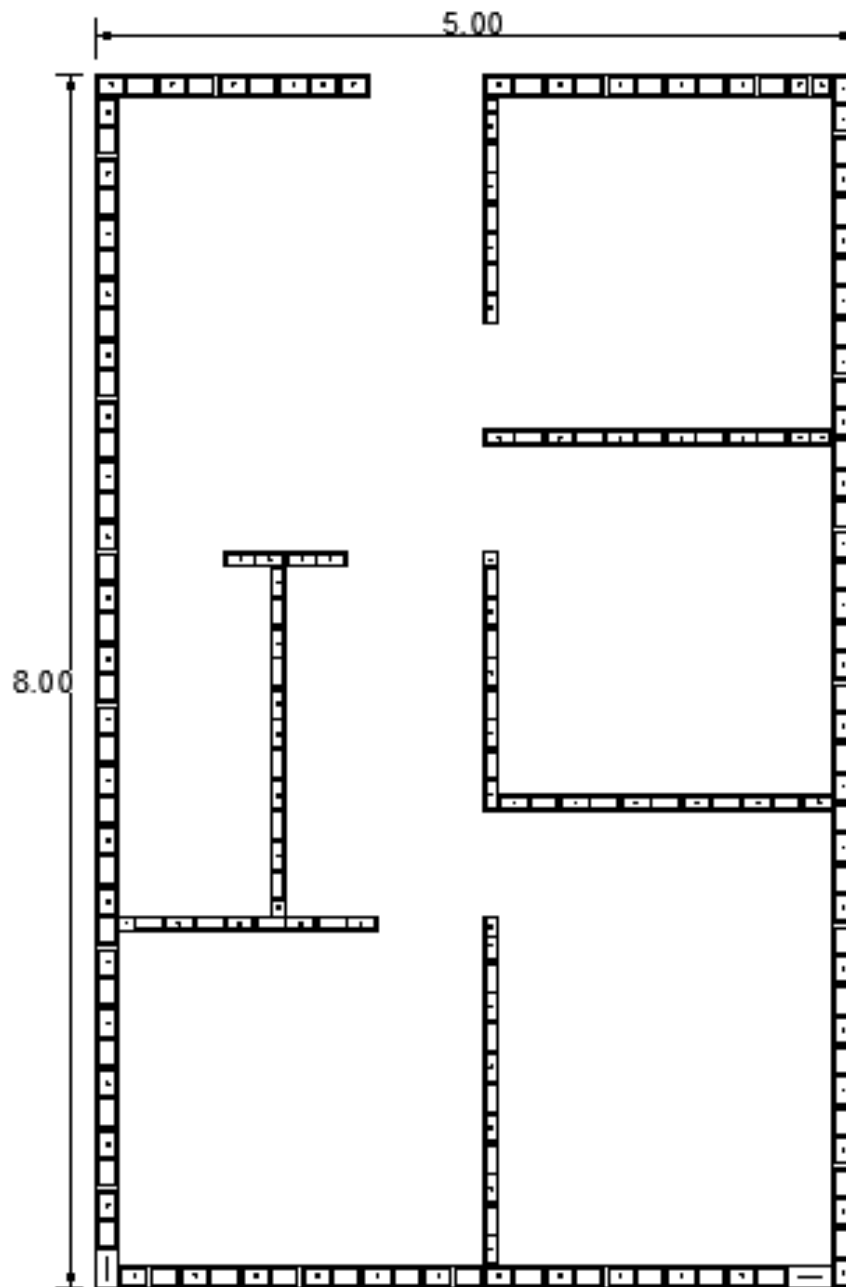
Planta de refuerzo de paredes de acuerdo a la Norma Especial para diseño y construcción de viviendas
